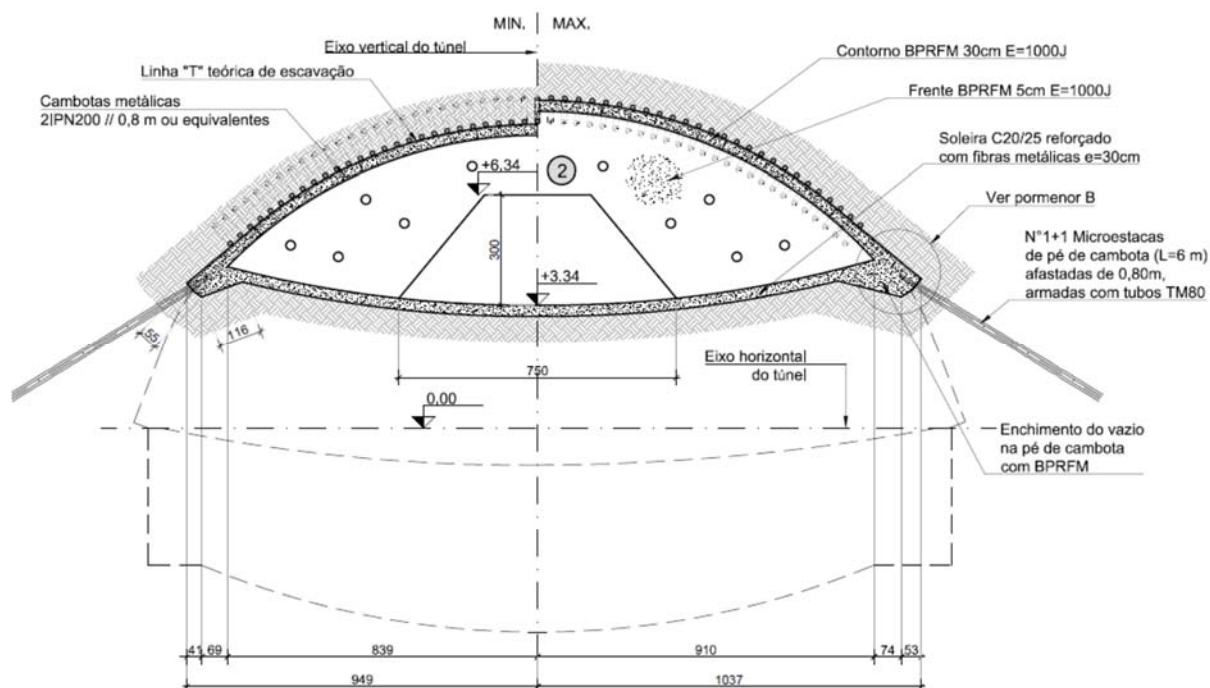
Secção tipo da fase 2 – calote superior - escavação e suporte primário em ZG3
